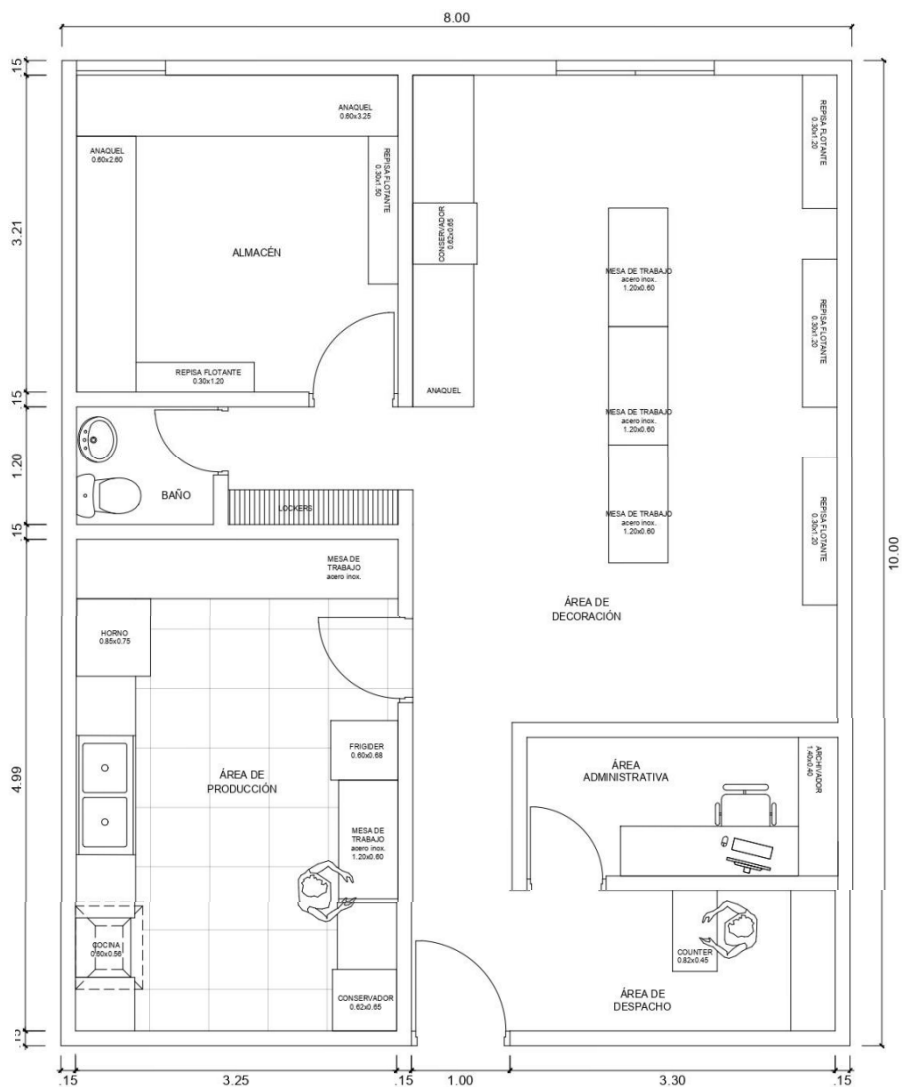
Plano de construcción de la pastelería La Tentación Cremosa
